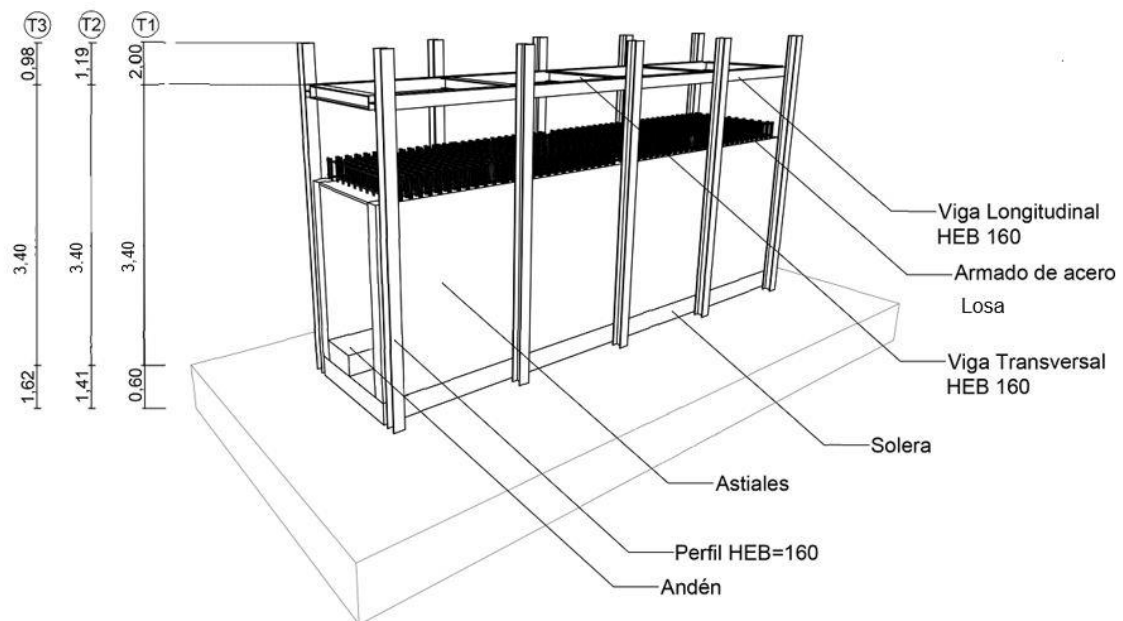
D7- Acero losa colector en sección de tramo 1-2-3
